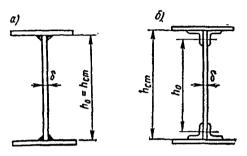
Расчетная высота стенки балки а — сварной; б — клепаной
